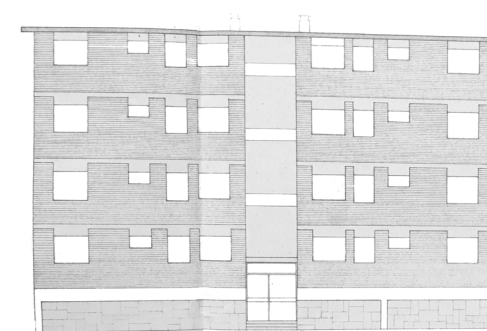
Plano del alzado Este (fachada frontal) del edificio ubicado en la Rúa Moaña-Coia, 5 (fotografía de autoría propia).
